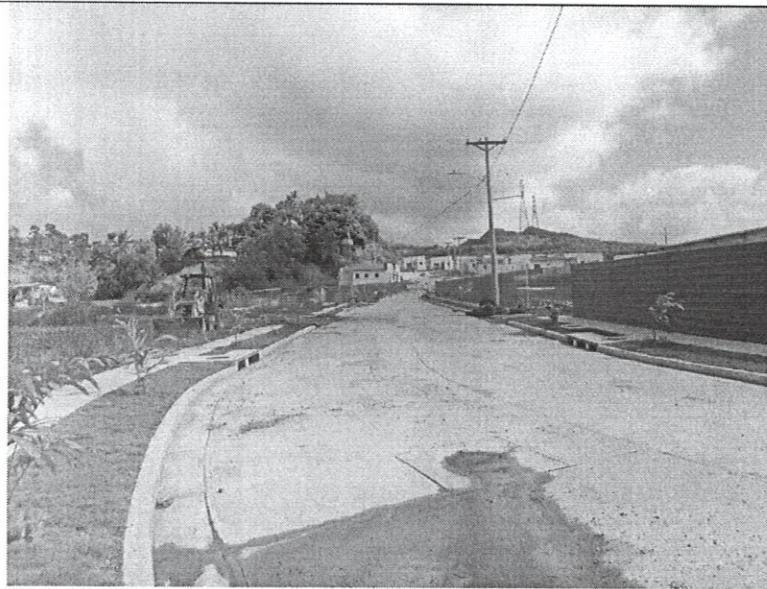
Calle principal de acceso al proyecto, propuesta dentro de la solicitud de modificación.
